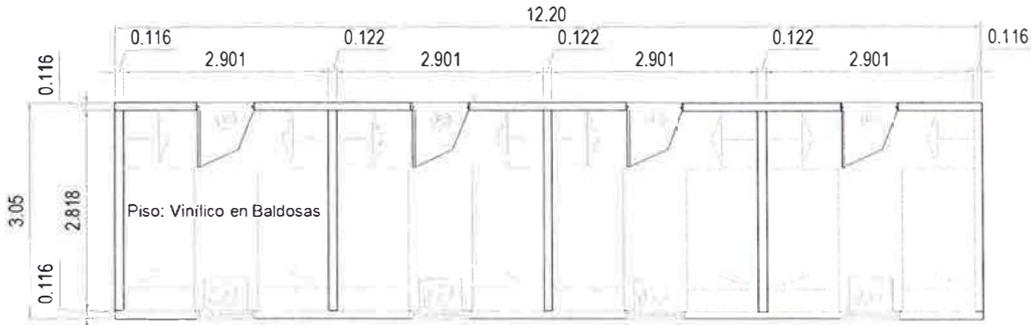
Vista en planta de módulo de baños para edificio de trabajadores
